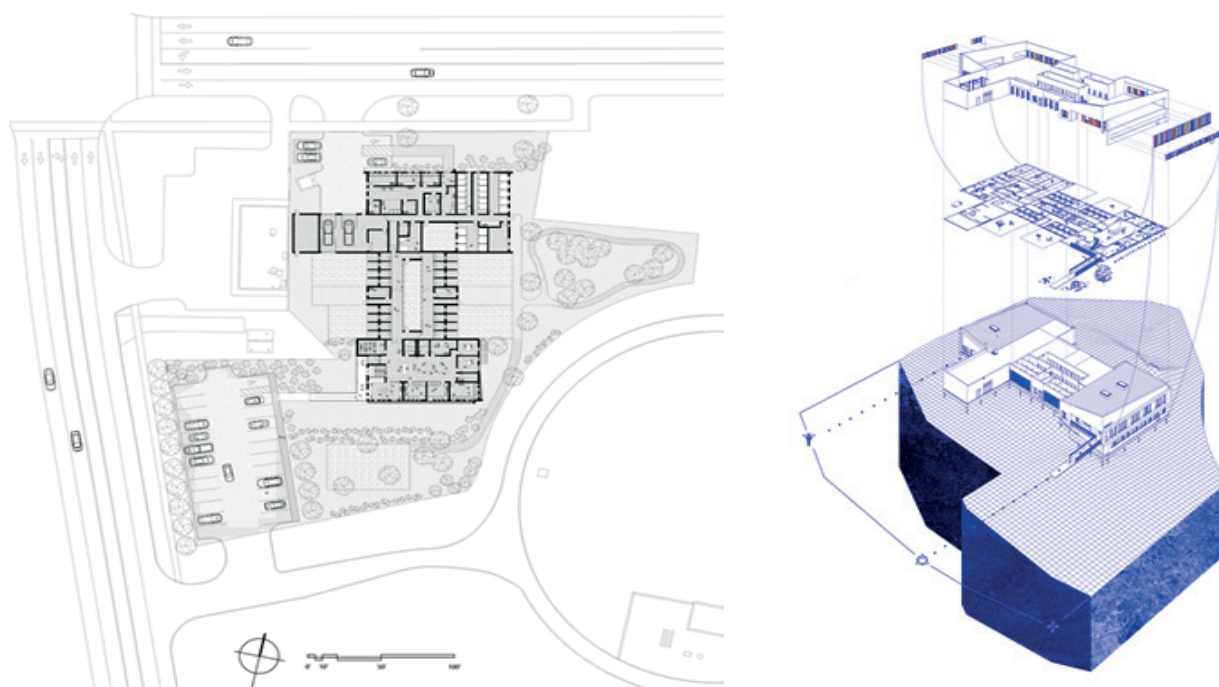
Генеральный план, совмещённый с планом 1-го этажа и суперпозиция [1]
